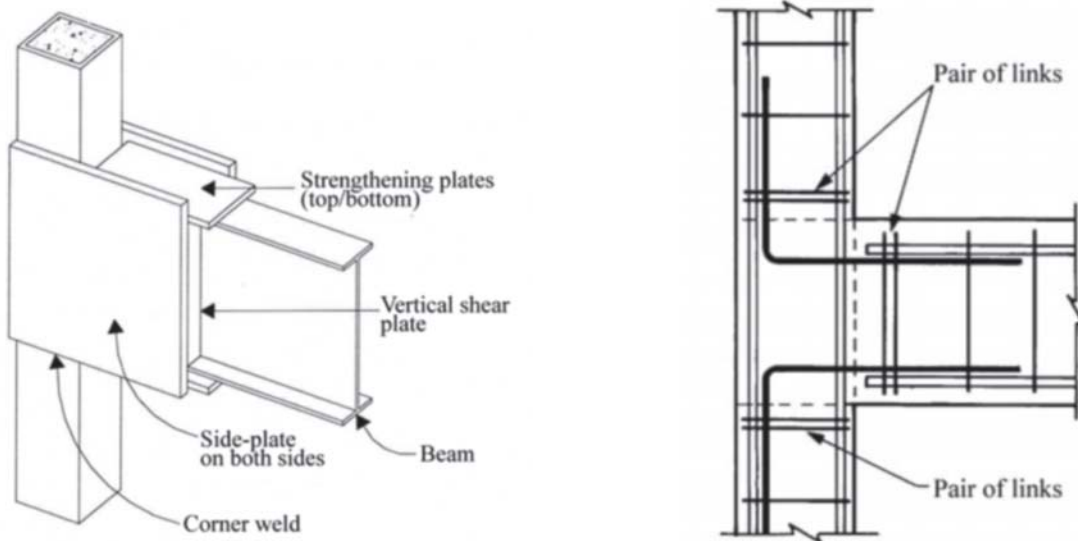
, Détails d'assemblage poutre-poteau amélioré pour ossature d'acier [10] et de béton armé [11].
